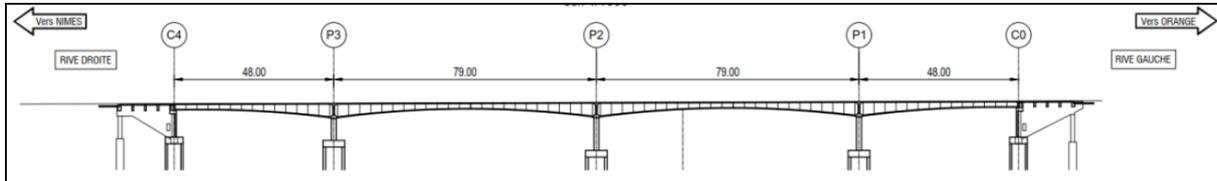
Coupe longitudinale de l'ouvrage (Arcadis, 2022)
